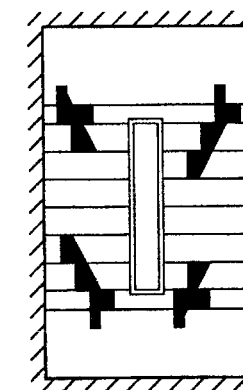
Scară din beton armat monolit cu grinzi de podest
